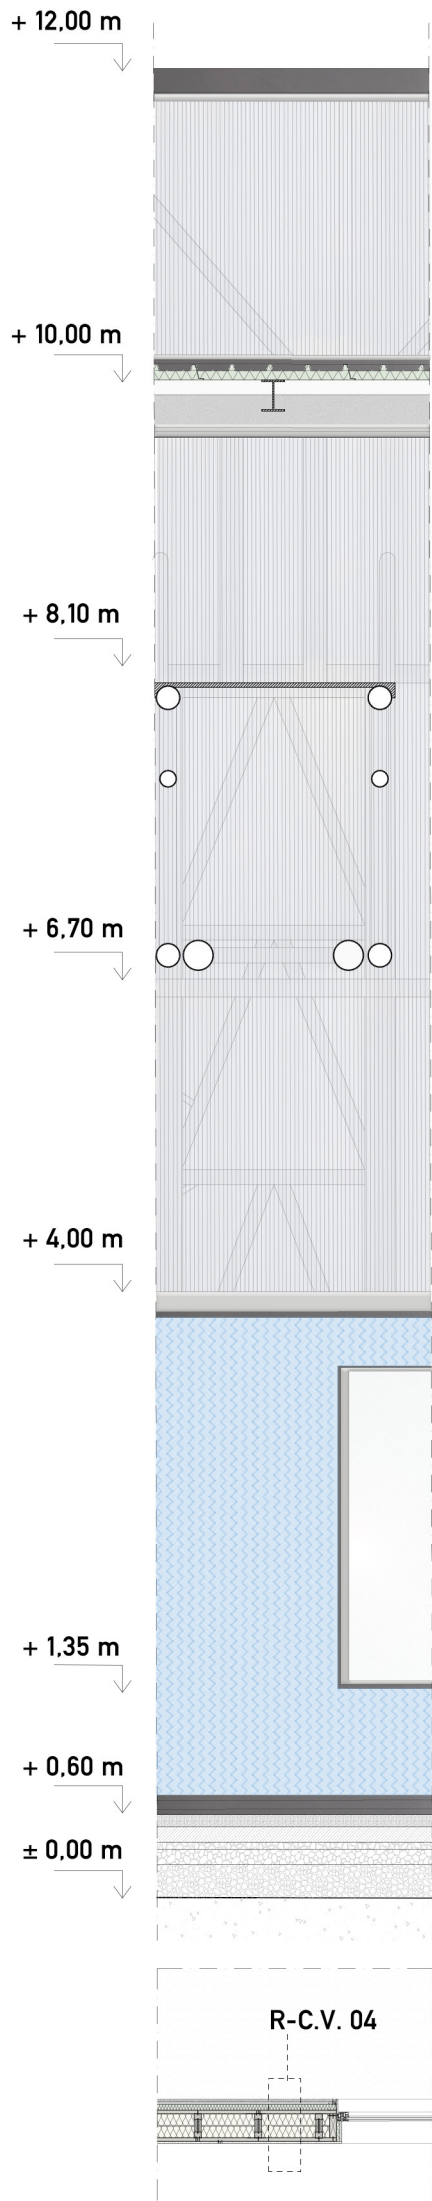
Tavola 66, Blow Up: prospetto ovest
